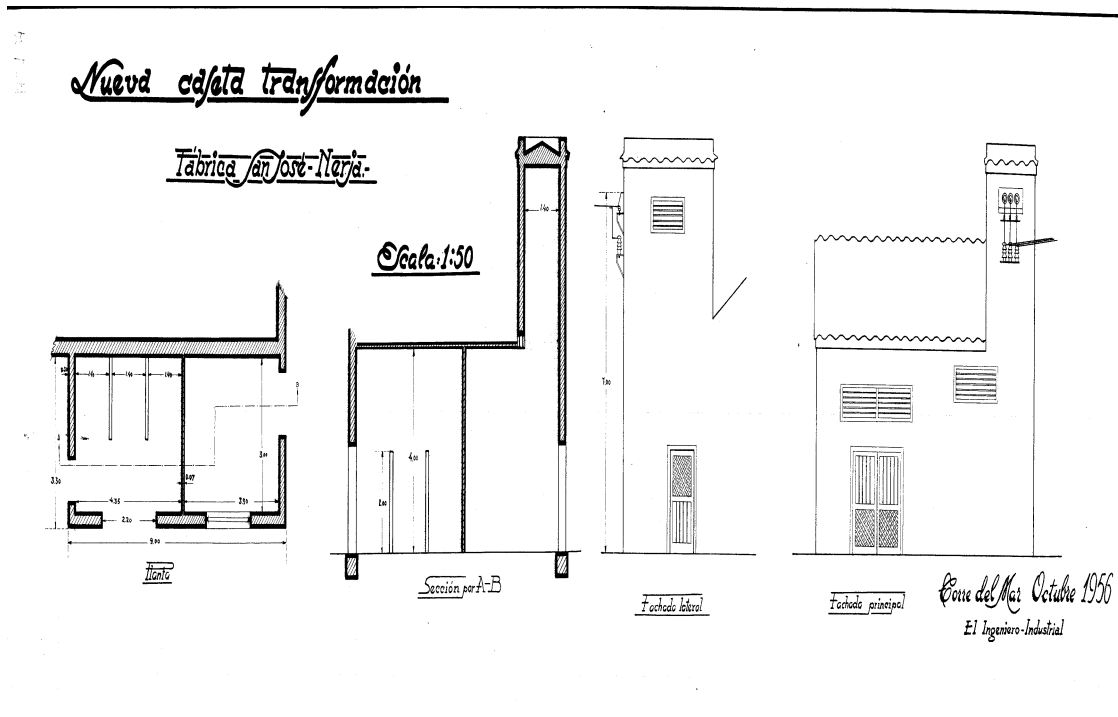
Plano de la nueva caseta de transformación de la azucarera de San José. Firma el ingeniero industrial Javier Bianchi. Torre del Mar, octubre de 1956. Fuente: ASAL
